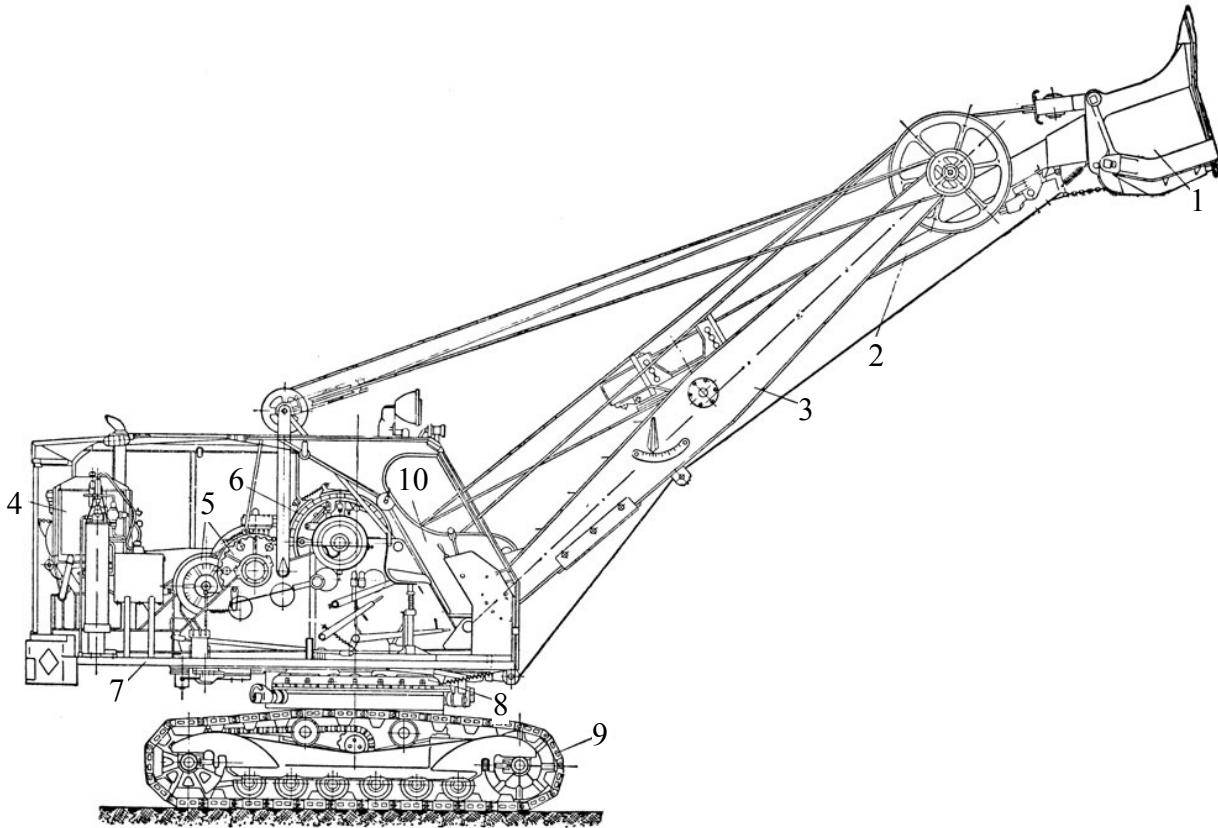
Гусеничний екскаватор з обладнанням «пряма лопата»: 1 – ківш; 2 – держак; 3 – стріла; 4 – двигун; 5 – передавальні механізми; 6 – головна лебідка; 7 – поворотна платформа; 8 – поворотний механізм; 9 – гусеничний хід; 10 – кабіна машиніста-екскаваторника
